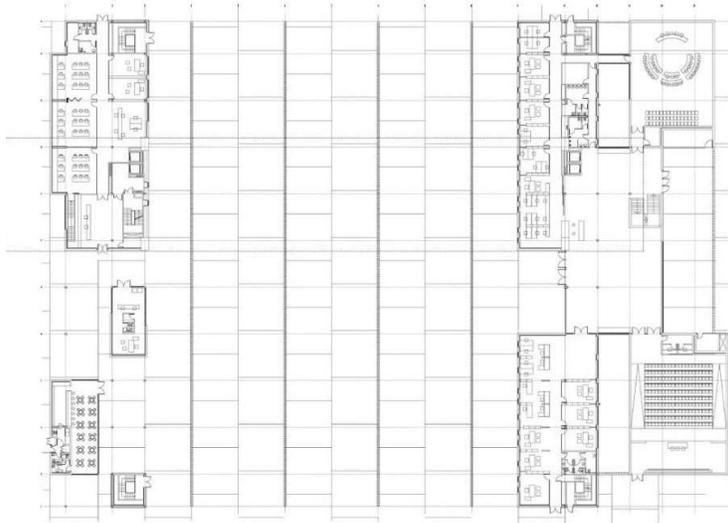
Planta Baja Ayuntamiento de Benidorm
